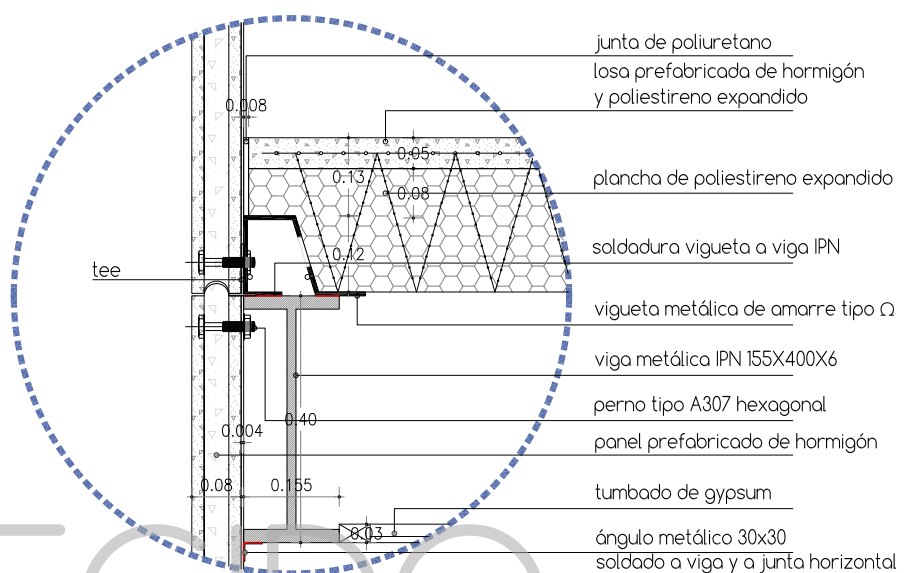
Detalle de vigueta perimetral-losa con paneles prefabricados
